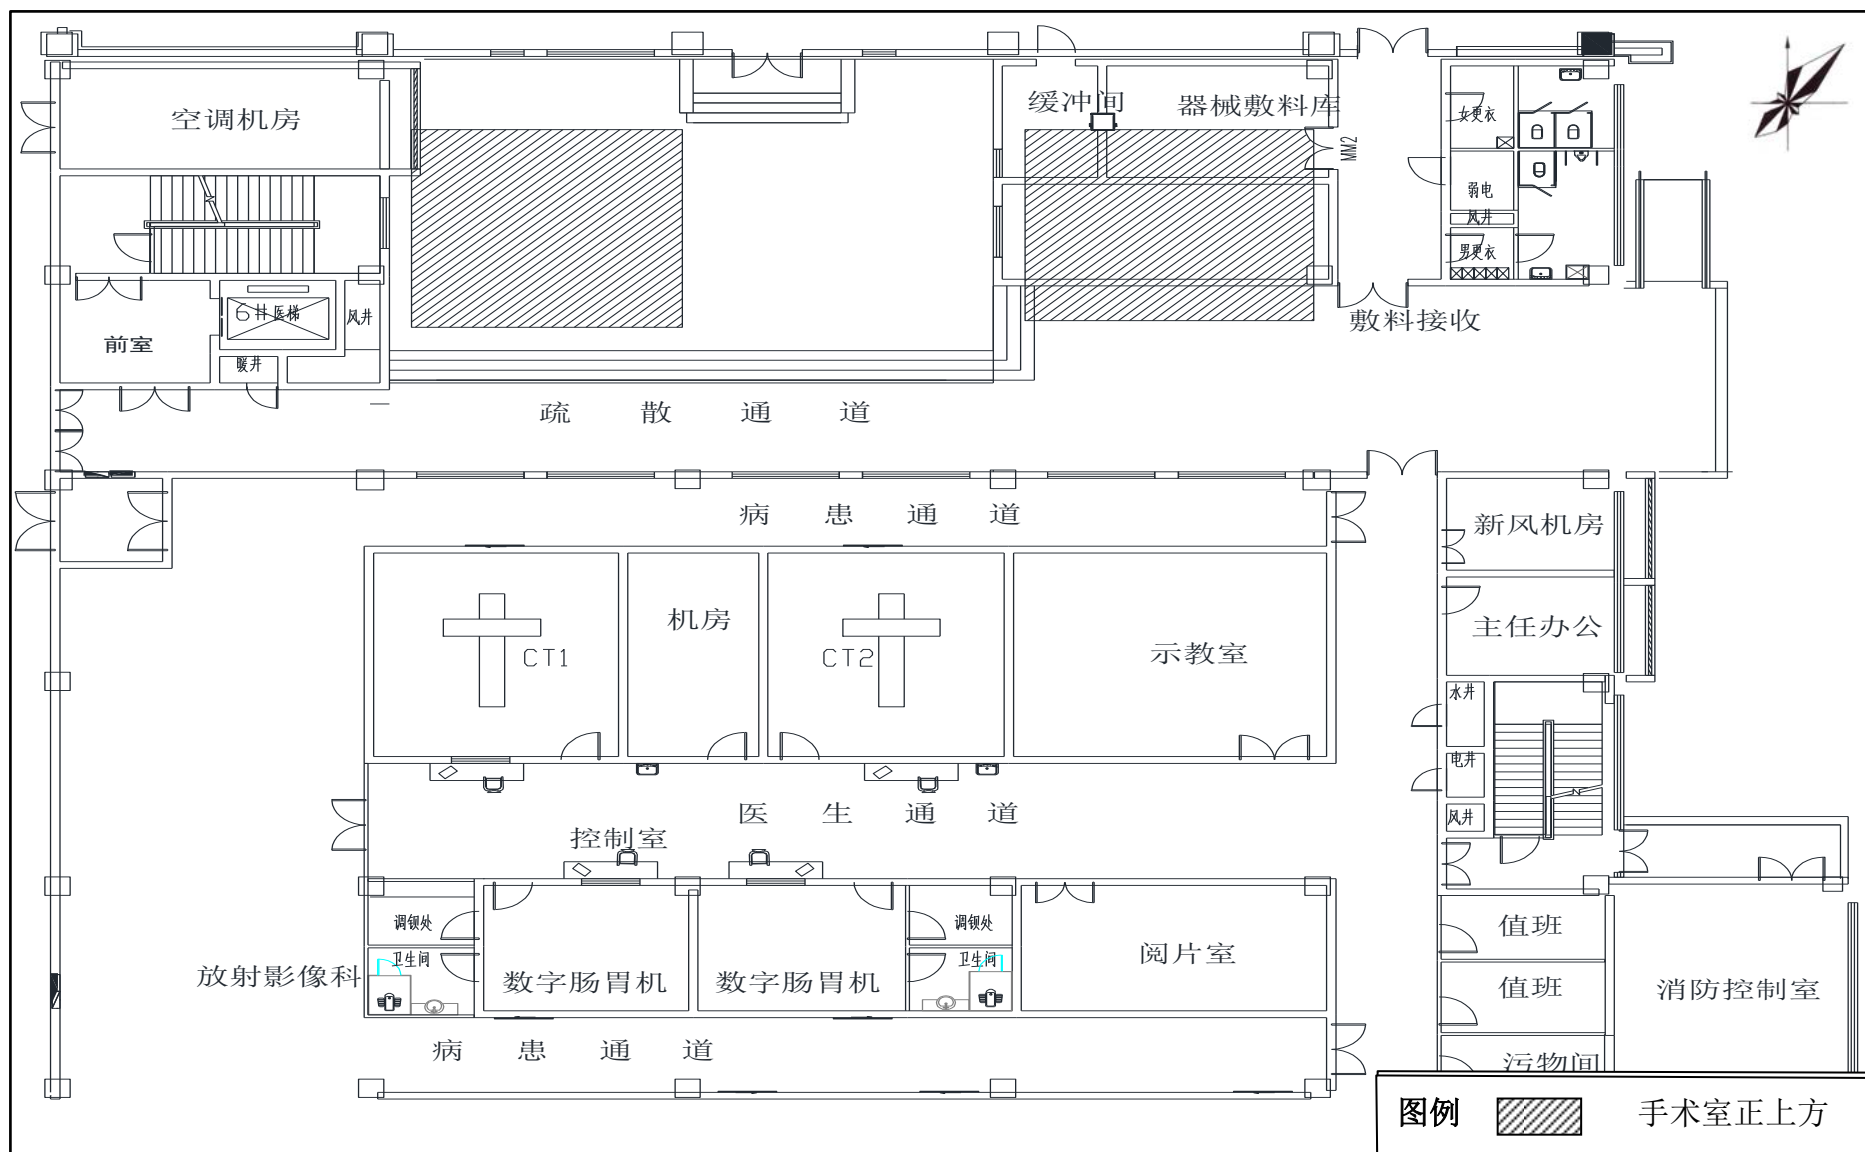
医疗综合楼一层部分（介入中心上方）平面布置图
